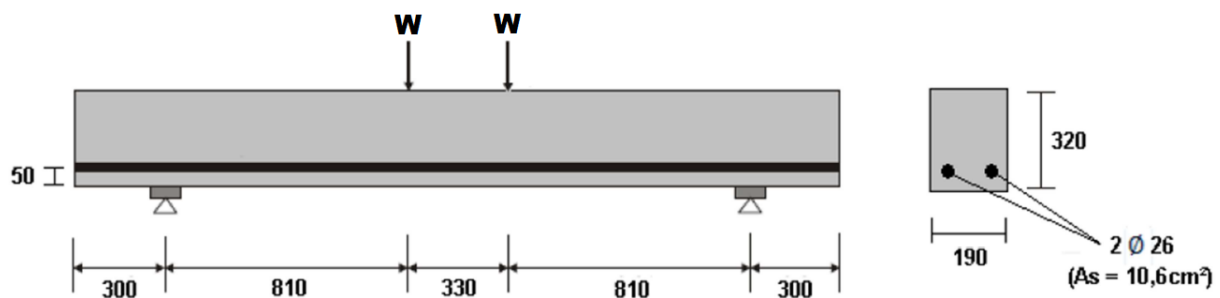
Dimensões em mm da viga ensaiada por Leonhardt e Walther (1962) *apud*. Lyra (2011).
